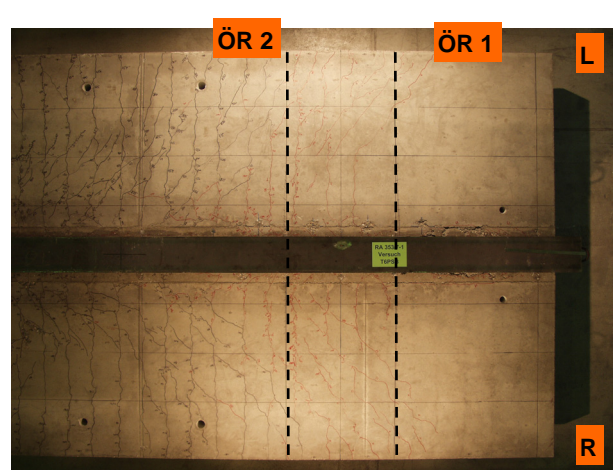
Rissbild auf der Betongurtunterseite
